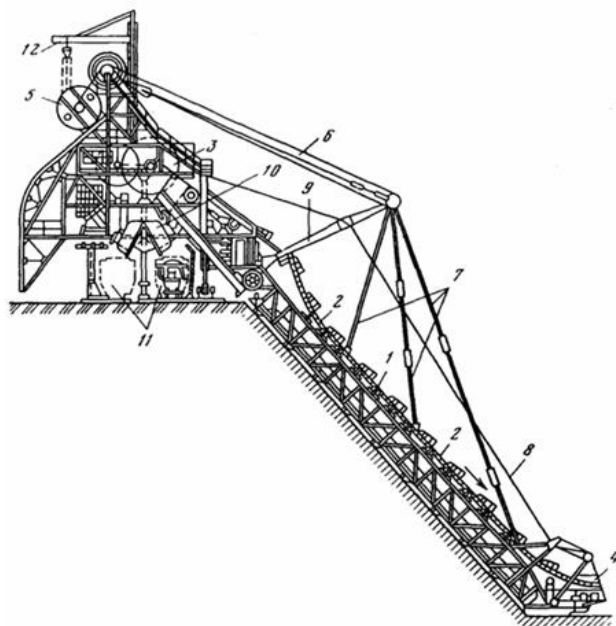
Схема ланцюгового багатоківшевого екскаватора: 1 – напрямна рама; 2 – ковшовий ланцюг; 3 – верхній барабан; 4 – плануюча ланка; 5 – рухома противага; 6 – канат для підвіски стріли; 7 – важелі для підвіски рами до стріли; 8 – канат для керування плануючою ланкою; 9 – стріла; 10 – завантажувальні люки; 11 – портали під екскаватором; 12 – кран для ремонту екскаватора
